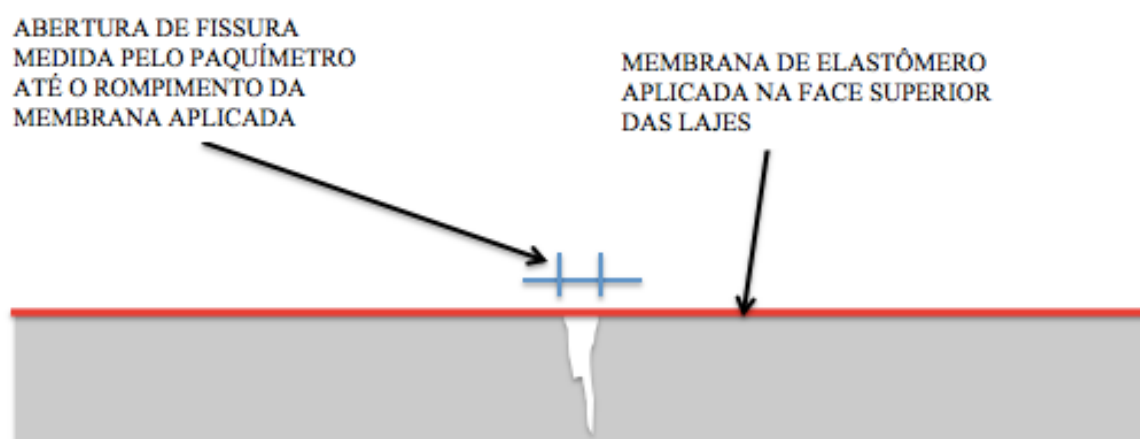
Croqui ilustrativo da maneira de medição das aberturas das fissuras na lateral das lajes com os sistemas impermeabilizantes aplicados
